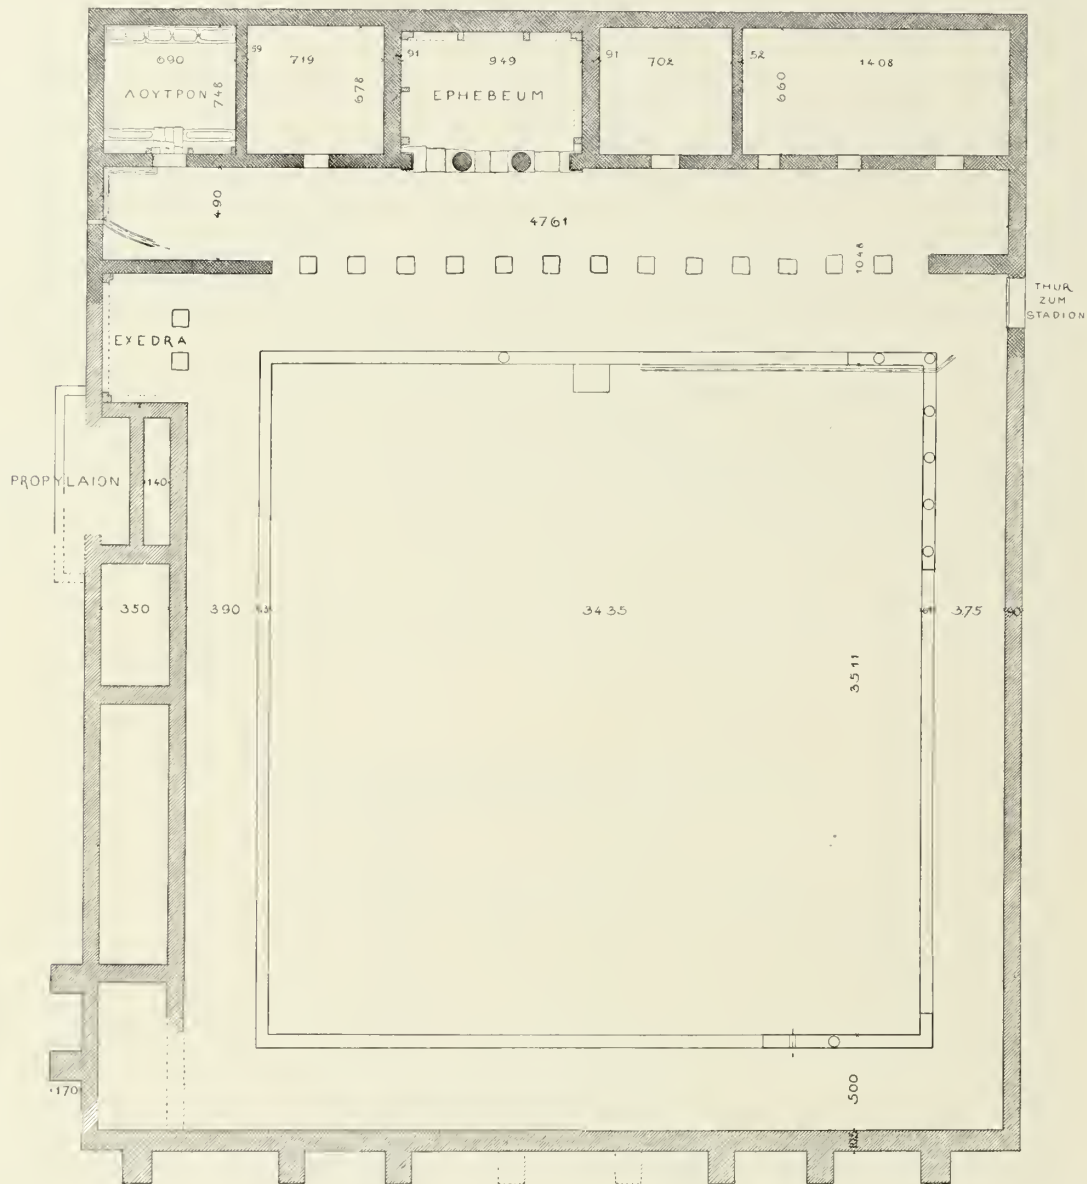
Grundriss des unteren Gymnasion.
